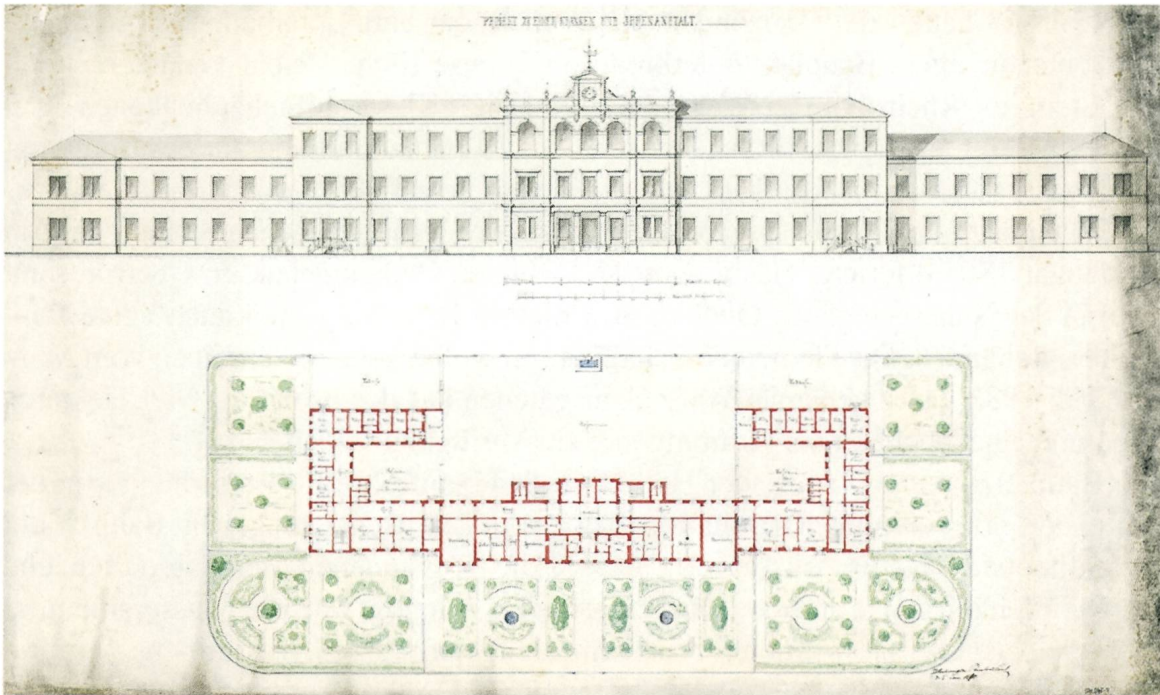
Projekt einer kombinierten Kranken- und Irrenanstalt, Aufriss und Grundriss EG mit Garten, Johann Christoph Bahnmaier, 6. Januar 1870. Das Projekt sah einen dreigeschossigen Mittelbau mit Verwaltungsräumen und Spital sowie zwei zweigeschossige Seitenflügel mit nach Geschlechtern getrennten Abteilungen für psychisch Kranke vor. Aquarellierte Federzeichnung, 127×74 cm. STASH SSH948-2.
